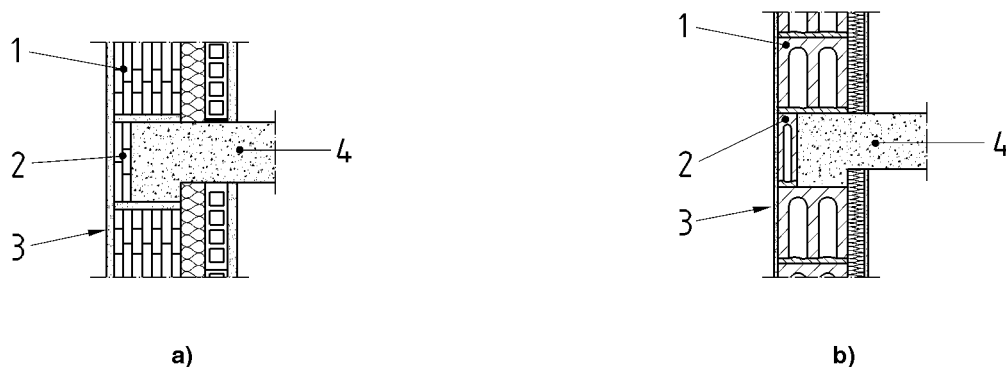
Exemples d'éléments de coffrage (Dimensions en mm)
